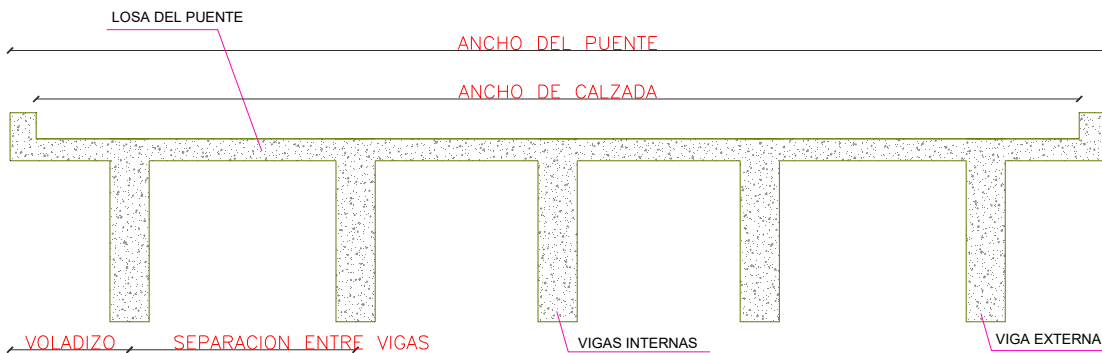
SECCION TIPICA TRANSVERSAL DE PUENTE TIPO LOSA Y VIGAS . FUENTE: PROPIA
